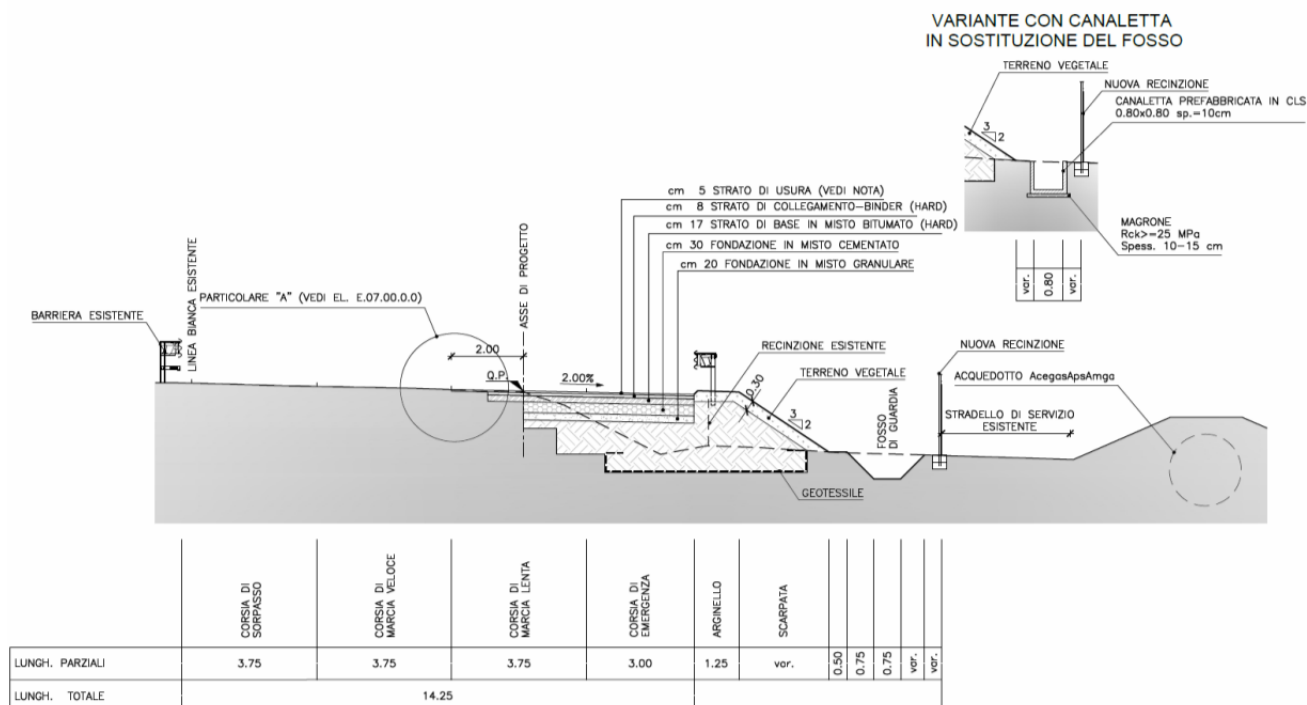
Estratto della tavola E.06.00.0.0 "Sezioni tipo", in cui è rappresentato il pacchetto di pavimentazione autostradale previsto in progetto.
